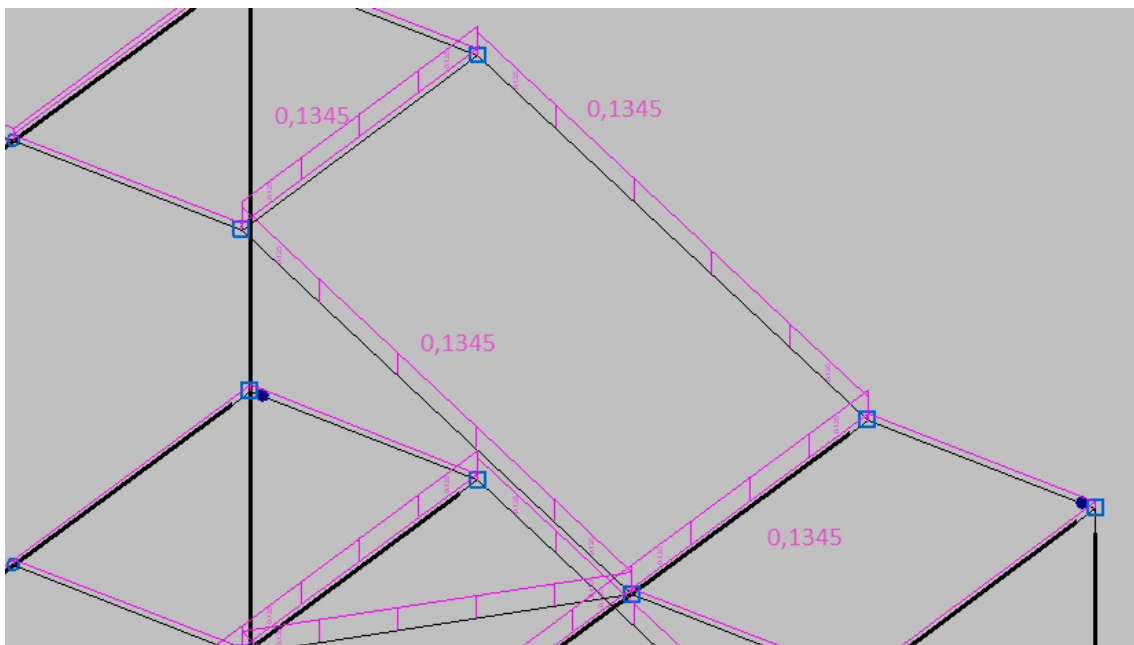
Cargas muertas sobre tramos bajos de las escaleras.
